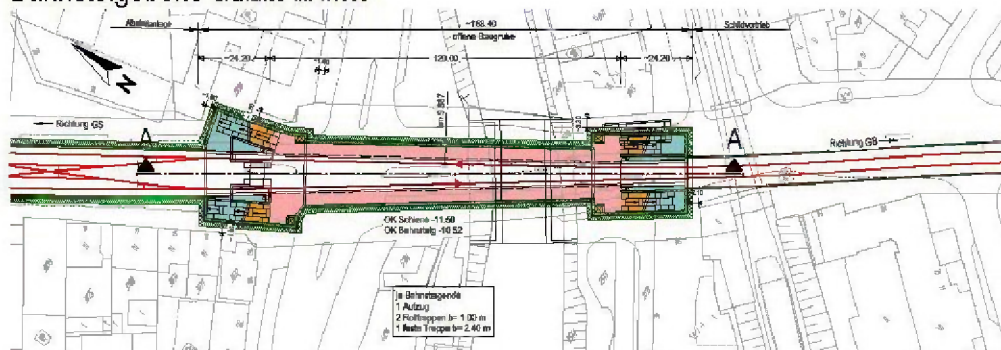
Lageplan Haltestelle Hoheluftbrücke I
